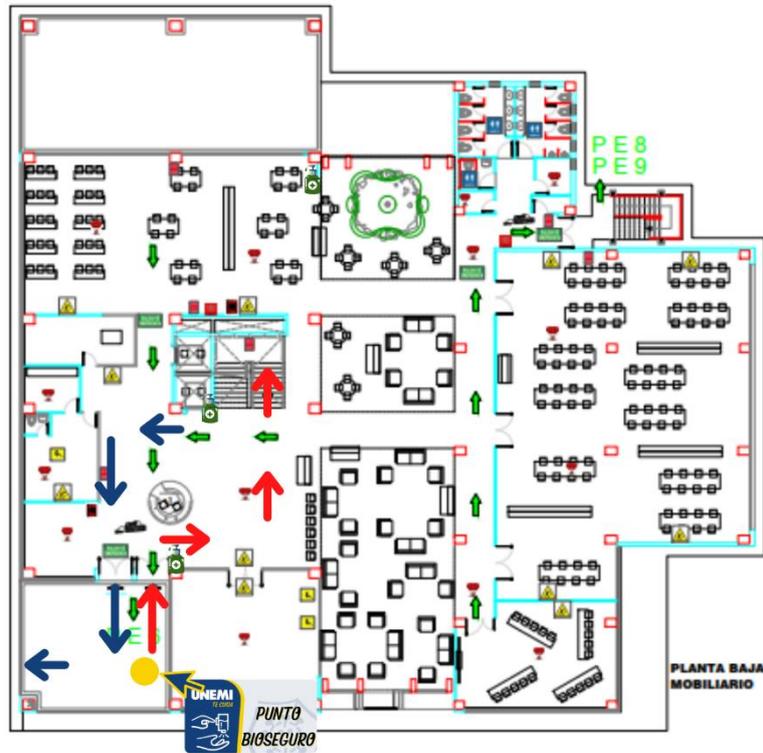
RUTA RECOMENDADA PLANTA BAJA CRAI
